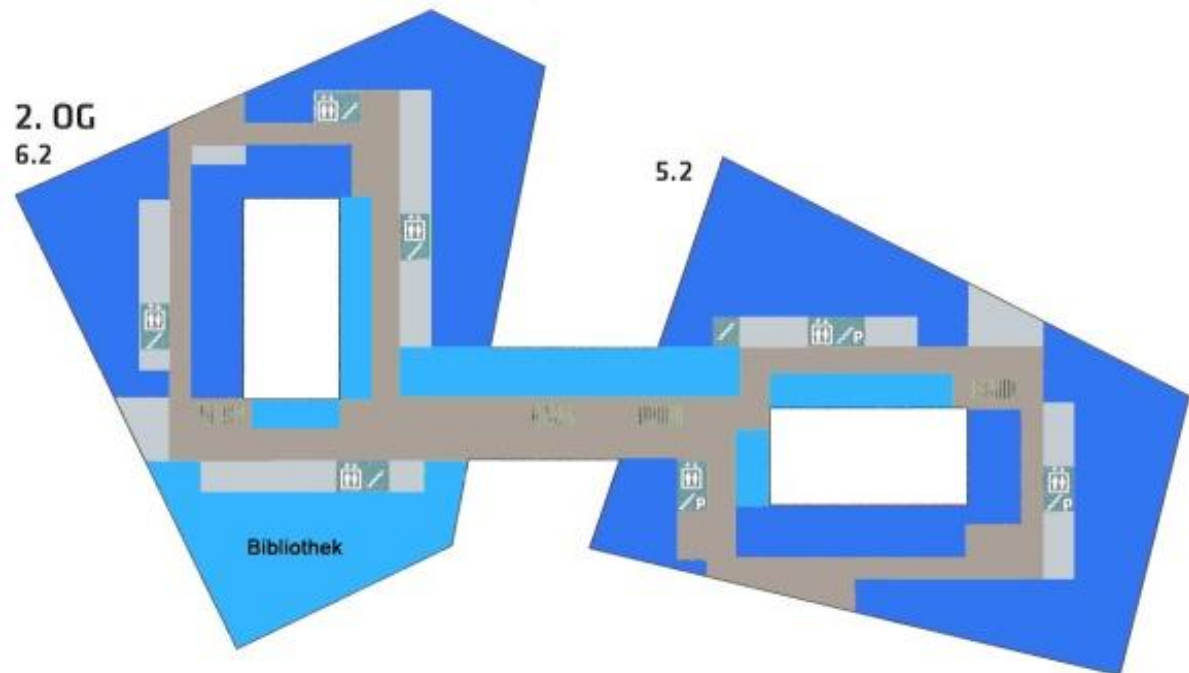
Grundriss FHNW Campus-Neubau Brugg-Windisch, 2. OG
